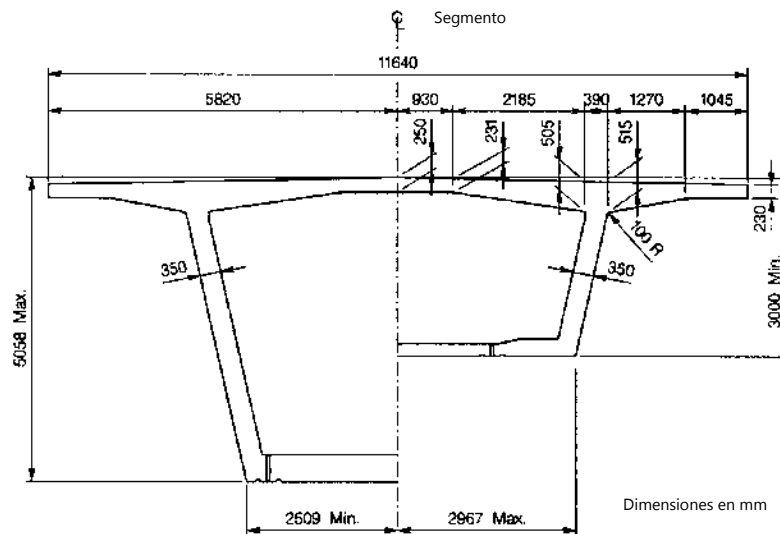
i Sección transversal típica para un puente de altura variable con claro de 93 m.
